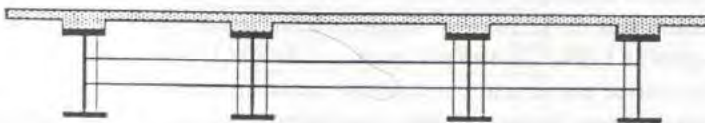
Coupe schématique d'un pont mixte multipoutre.
